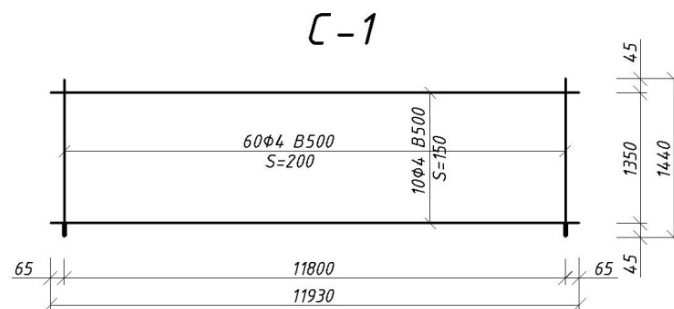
Армирование плиты поперечным каркасом.
